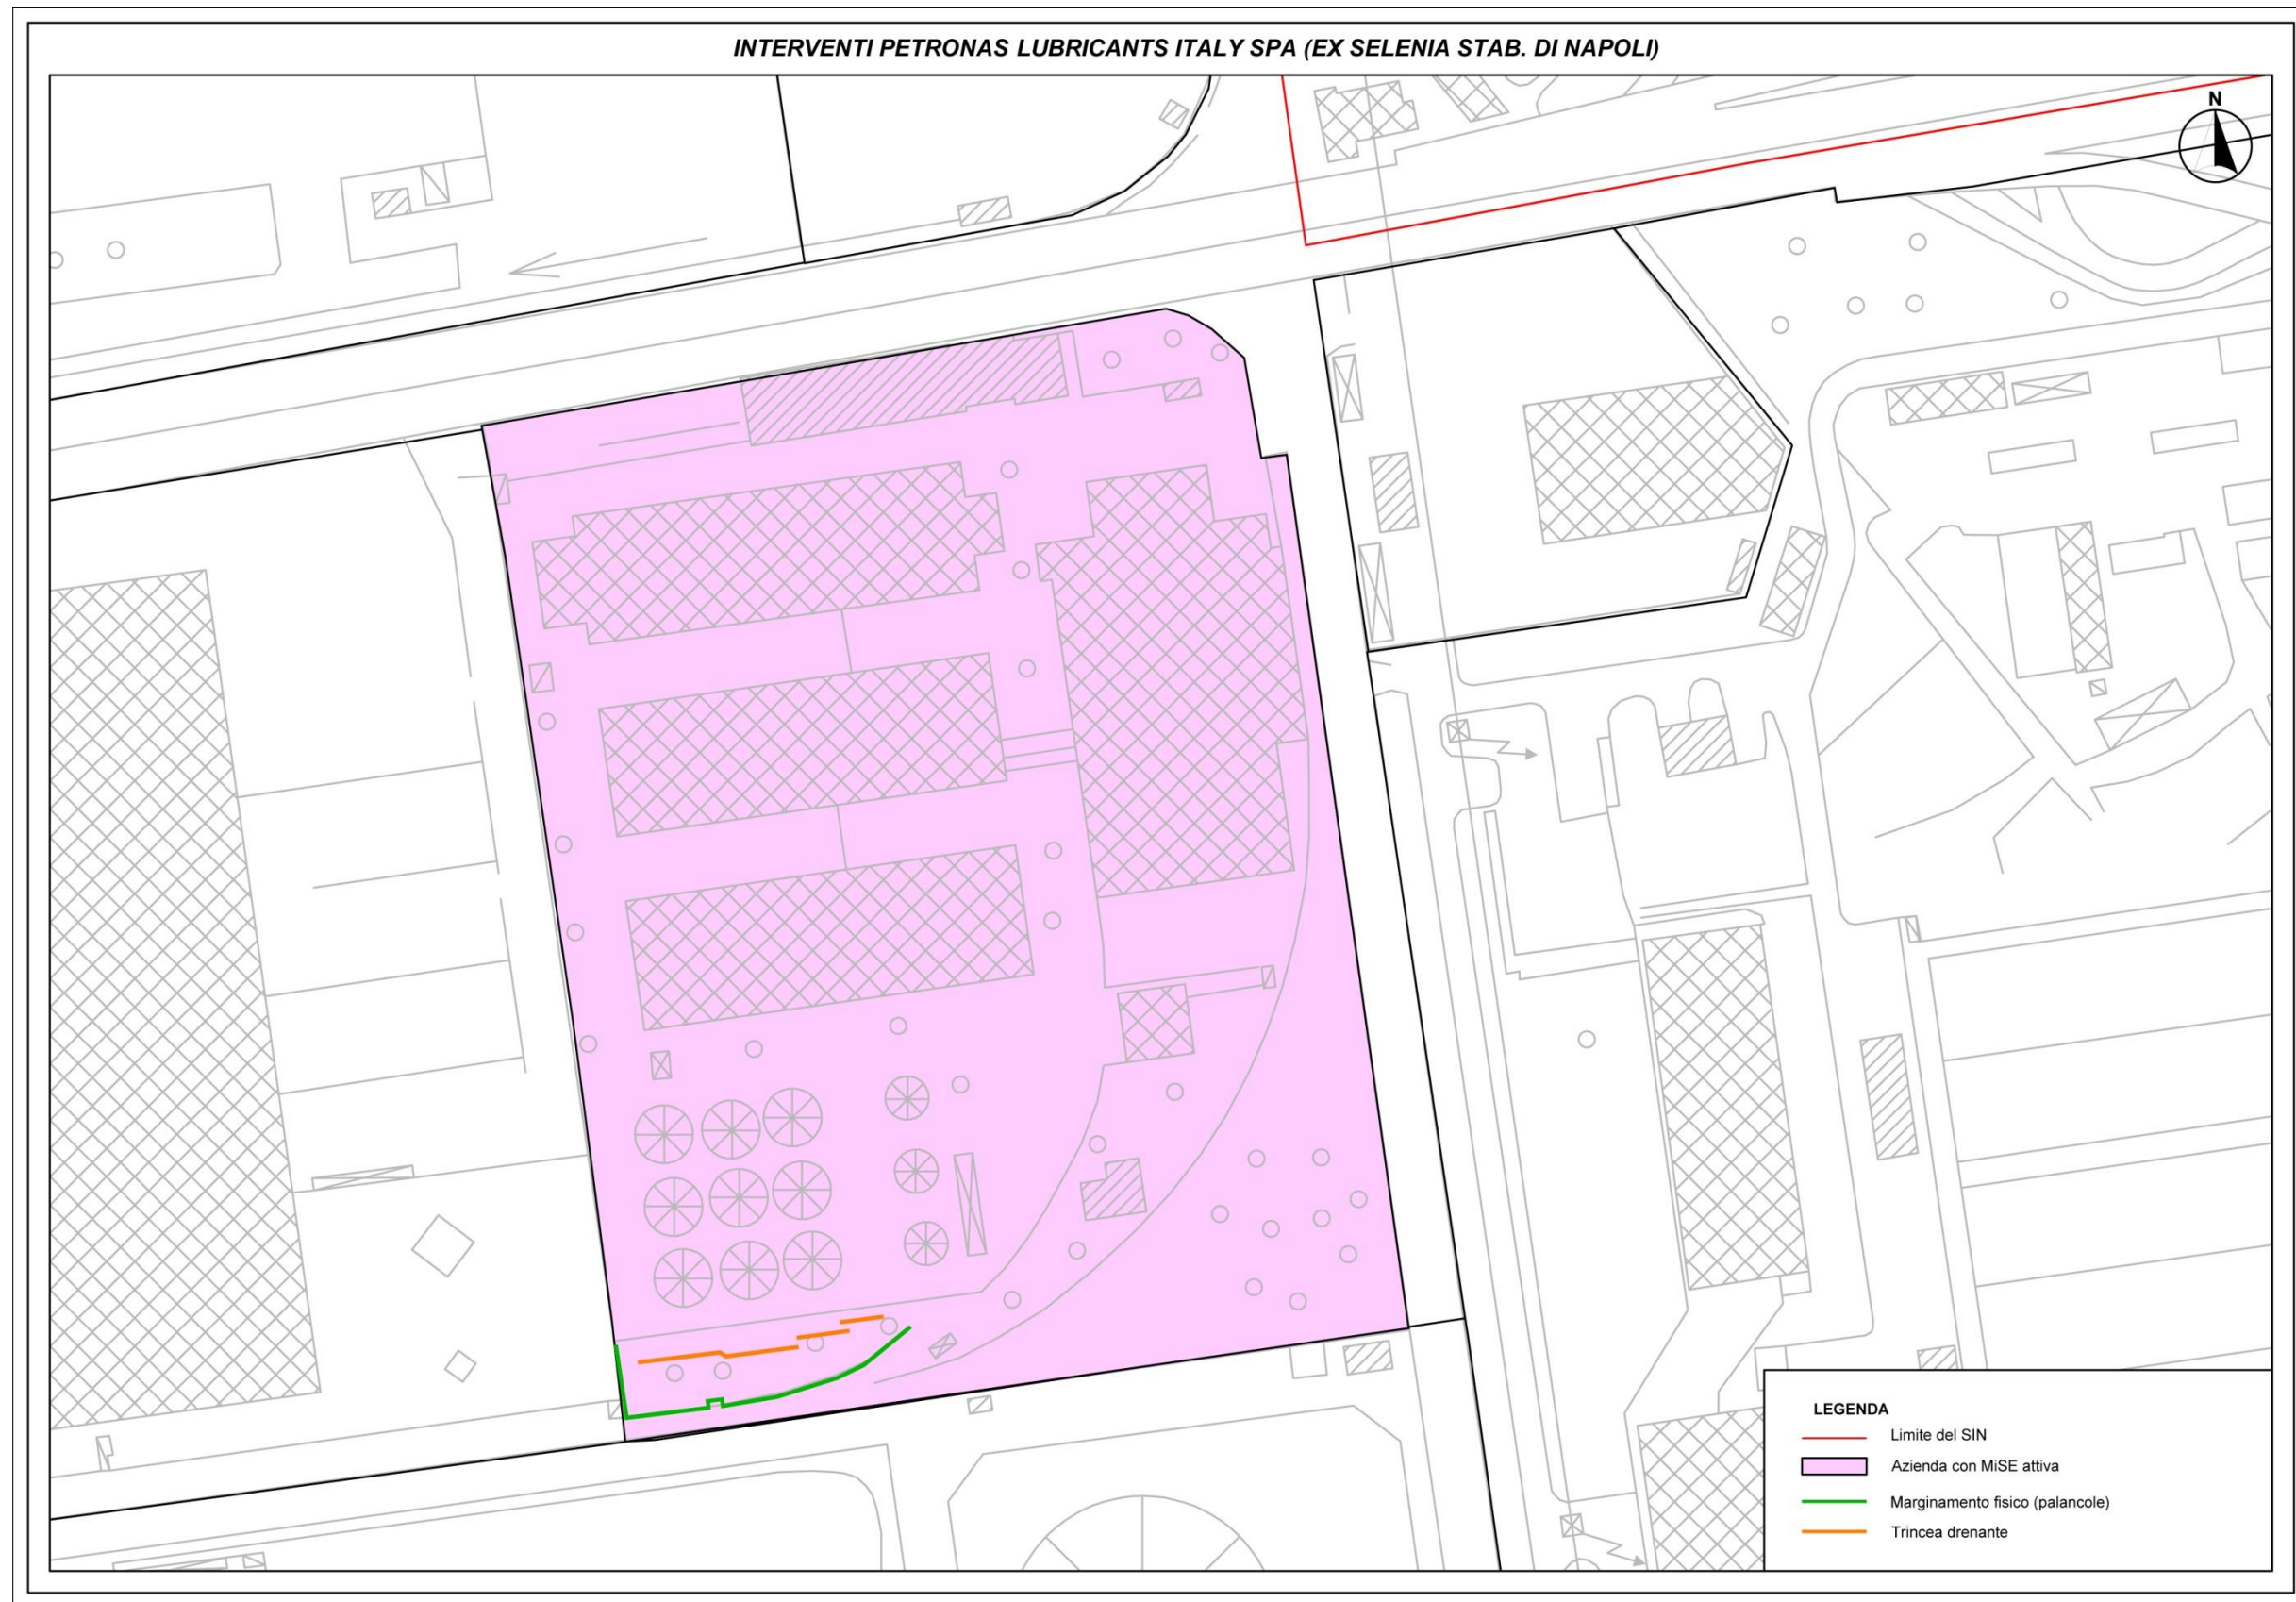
Planimetria intervento Messa in Sicurezza delle acque di falda
